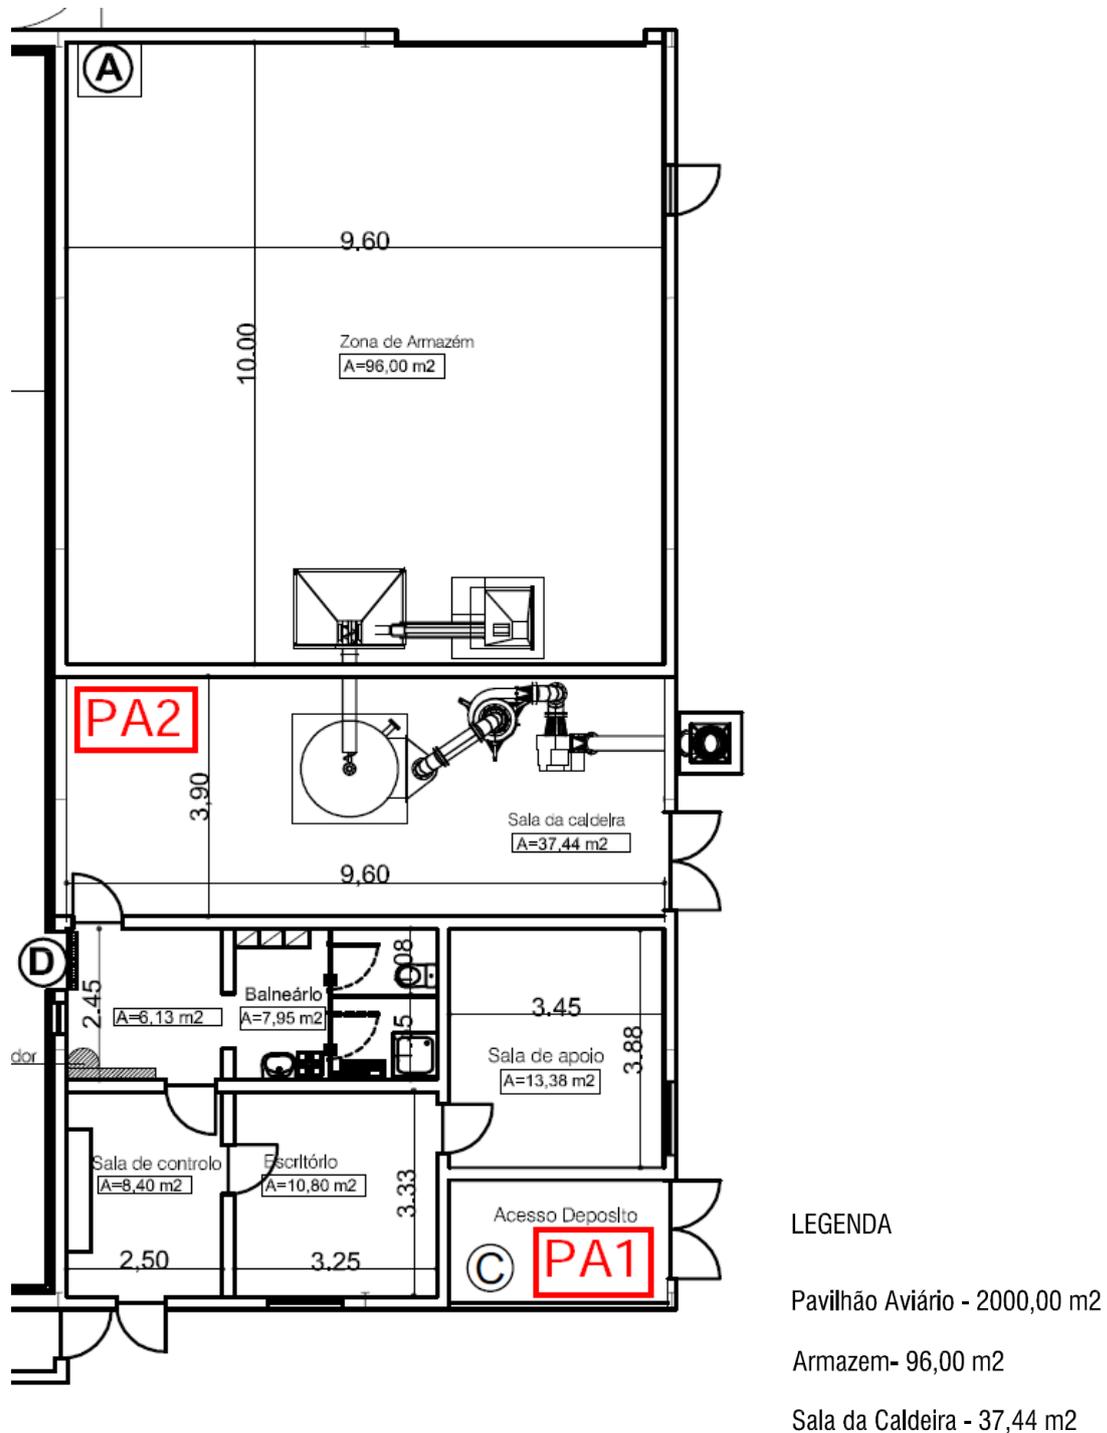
Extrato da planta de arquitetura com pormenor do anexo de apoio.
